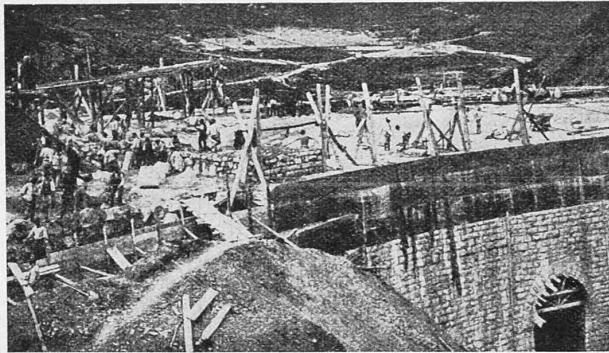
Beginn des Pfeilaraubaues über der Fundamentmauer („Tampone“) mit dem Grundablass.
